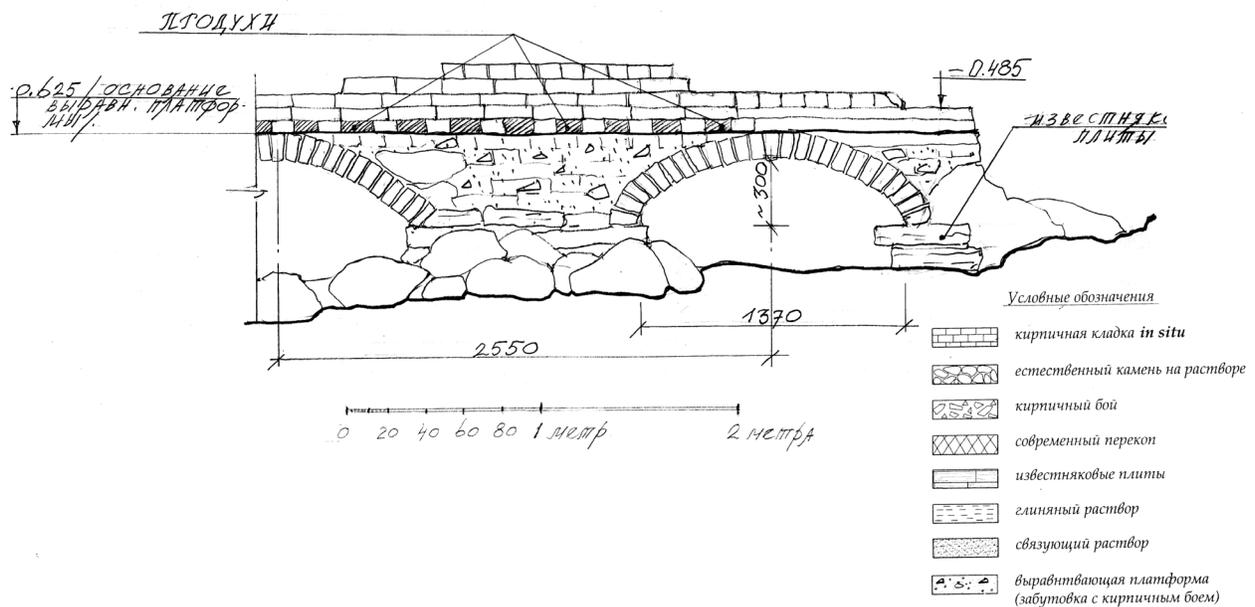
Северная оранжерея. Фрагмент: фундаментная арка
